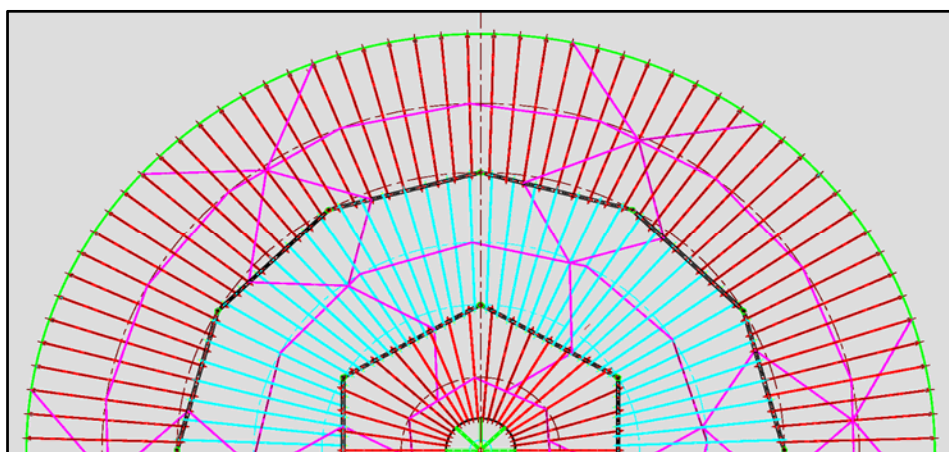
Vista superior de la estructura de un tanque con techo cónico soportado
